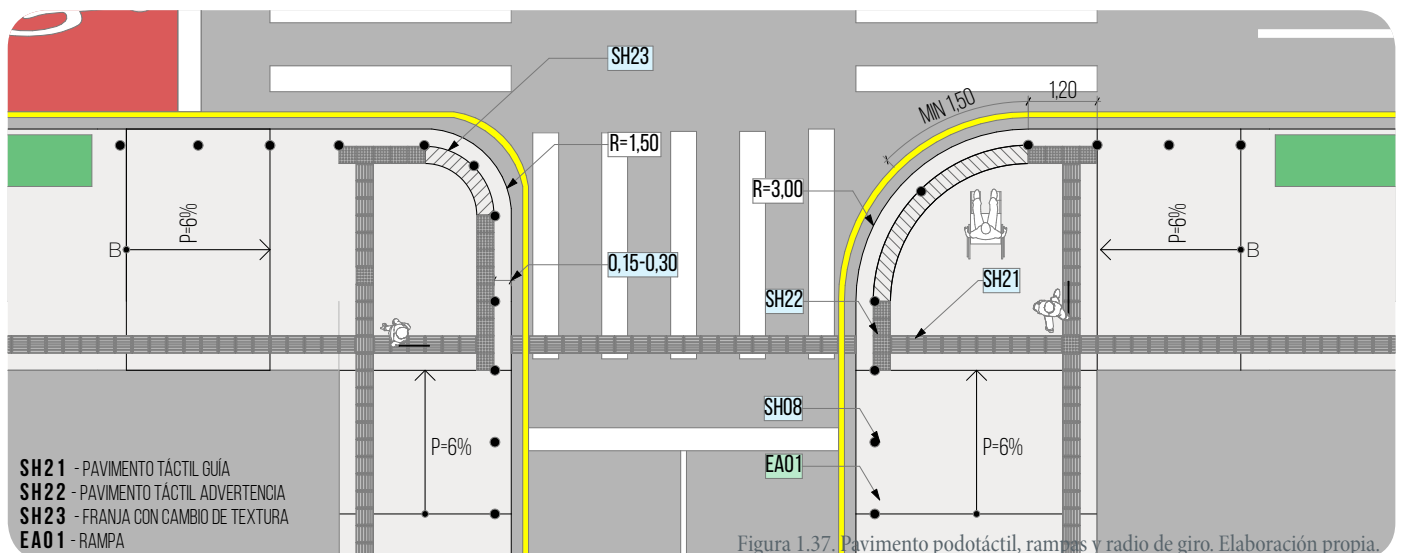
Pavimento podotáctil, rampas y radio de giro. Elaboración propia.
